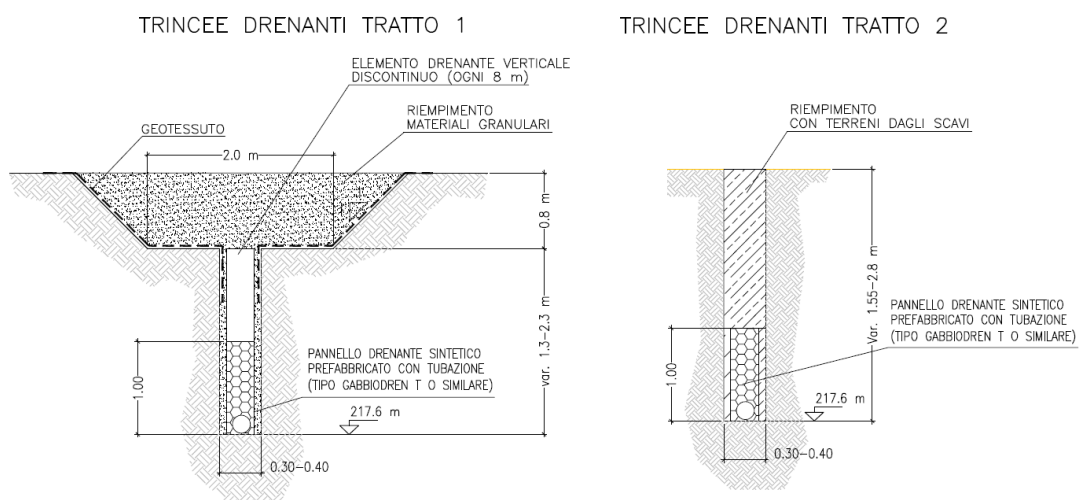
Sezioni tipiche della trincea drenante
